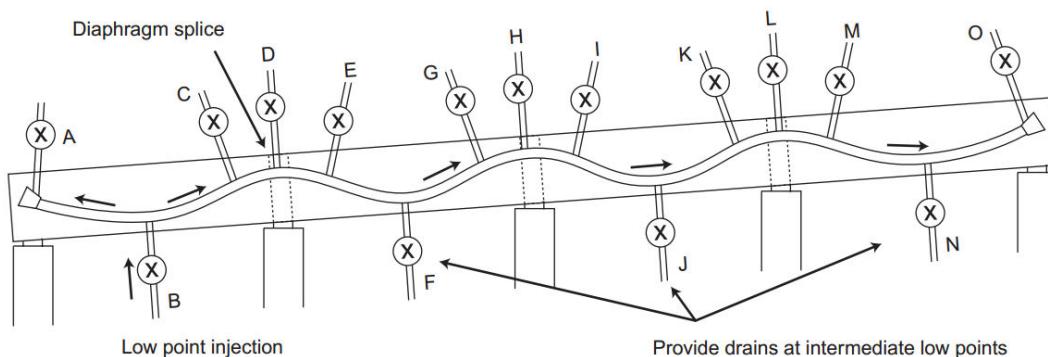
Detalles del grouting para un sistema de ducto de una viga principal empalmada de 4-tramos.
